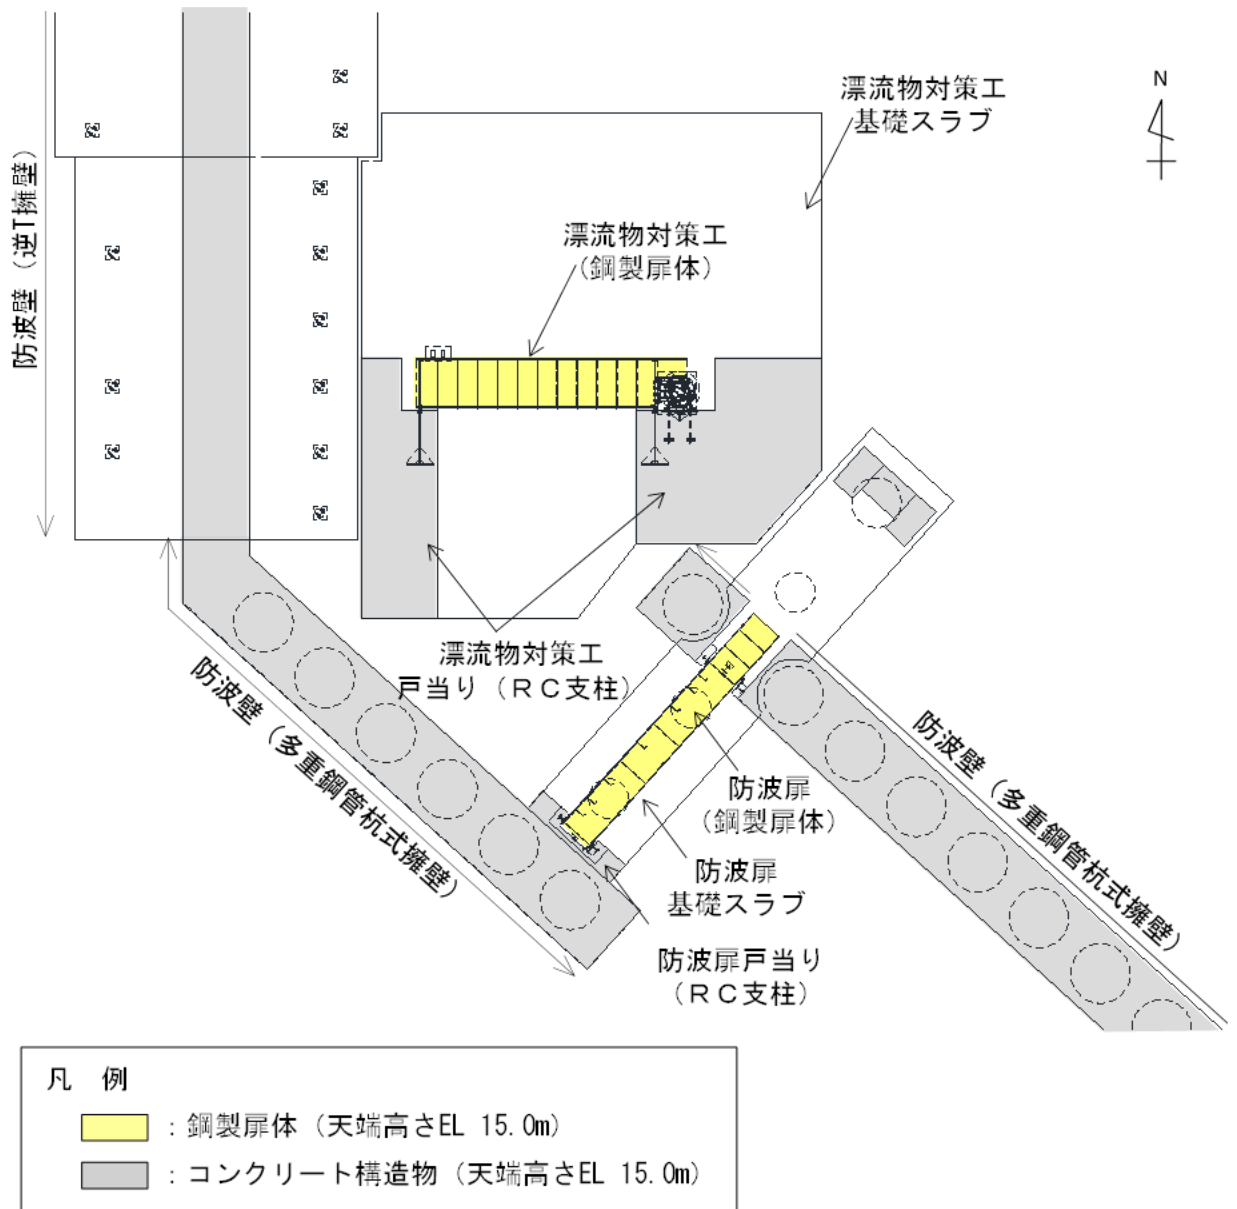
(2) 防波扉 (荷揚場南) の構造概要図 (平面図)
